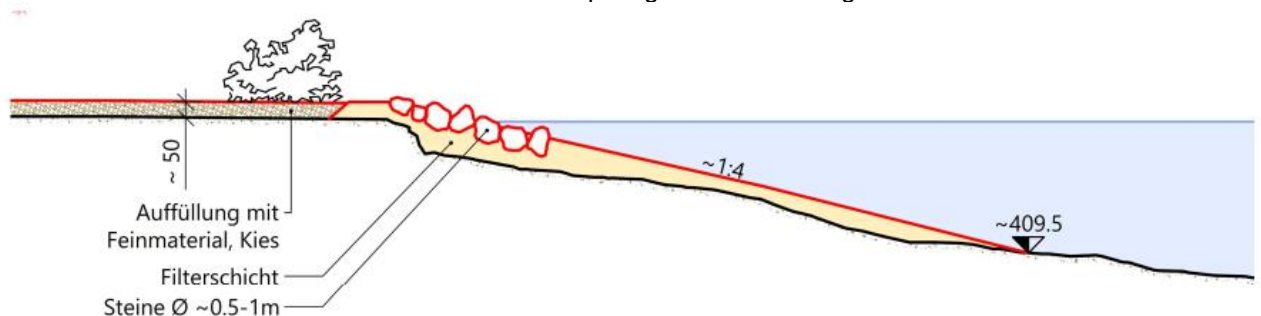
Schnitt durch geplante Sanierung der Buhnen, Stand Bauprojekt (August 2024)
